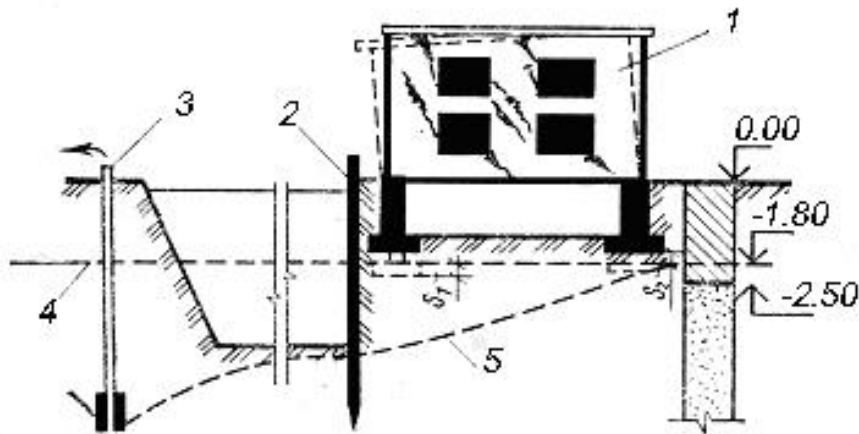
Деформація будівлі внаслідок пониження рівня підземних вод голкофільтровою установкою: 1 – будівля; 2 – шпунт; 3 – голкофільтр; 4 – рівень підземних вод до водозниження; 5 – те саме після водозниження
